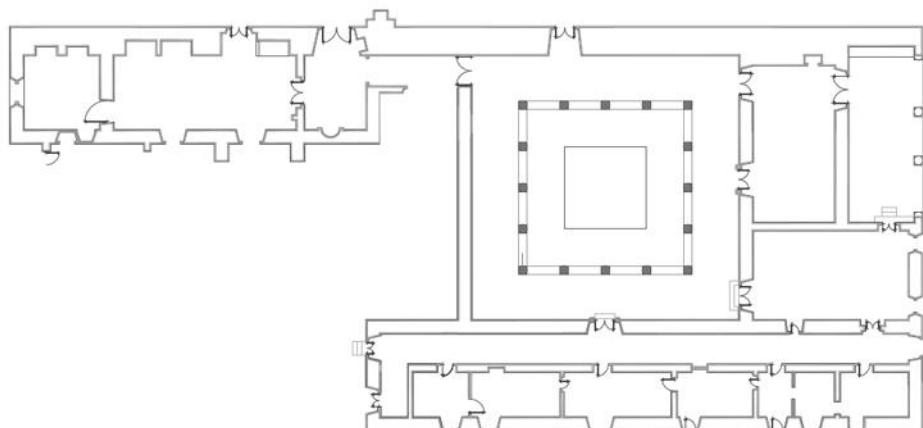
Planta arquitectónica, etapa constructiva 1550-1578⁵⁴
